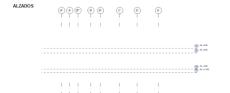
Configuración de estilos de ejes en planta arquitectónica - Revit 2024.
